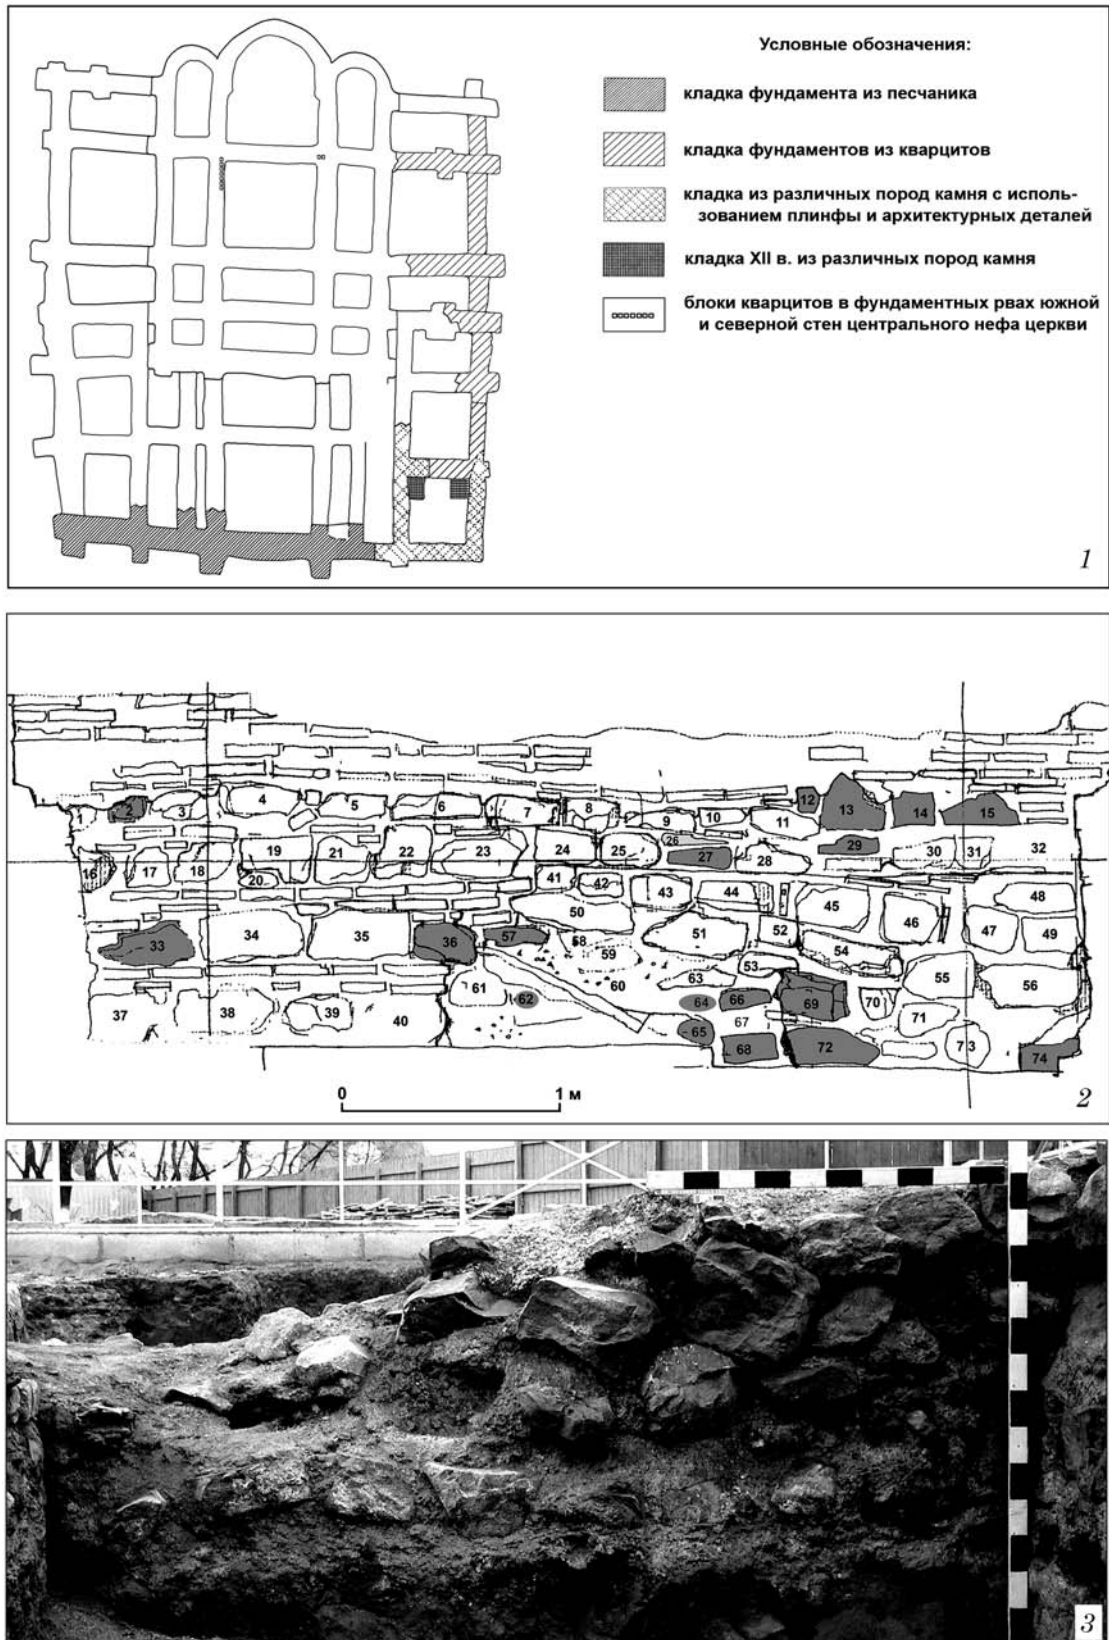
1 — План Десятинної церкви; 2 — План внутрішнього фасаду південного прясла західної стіни з позначеними кварцитами; 3 — Фундамент 1-ої (із заходу) перемички південної стіни Десятинної церкви. Фото
